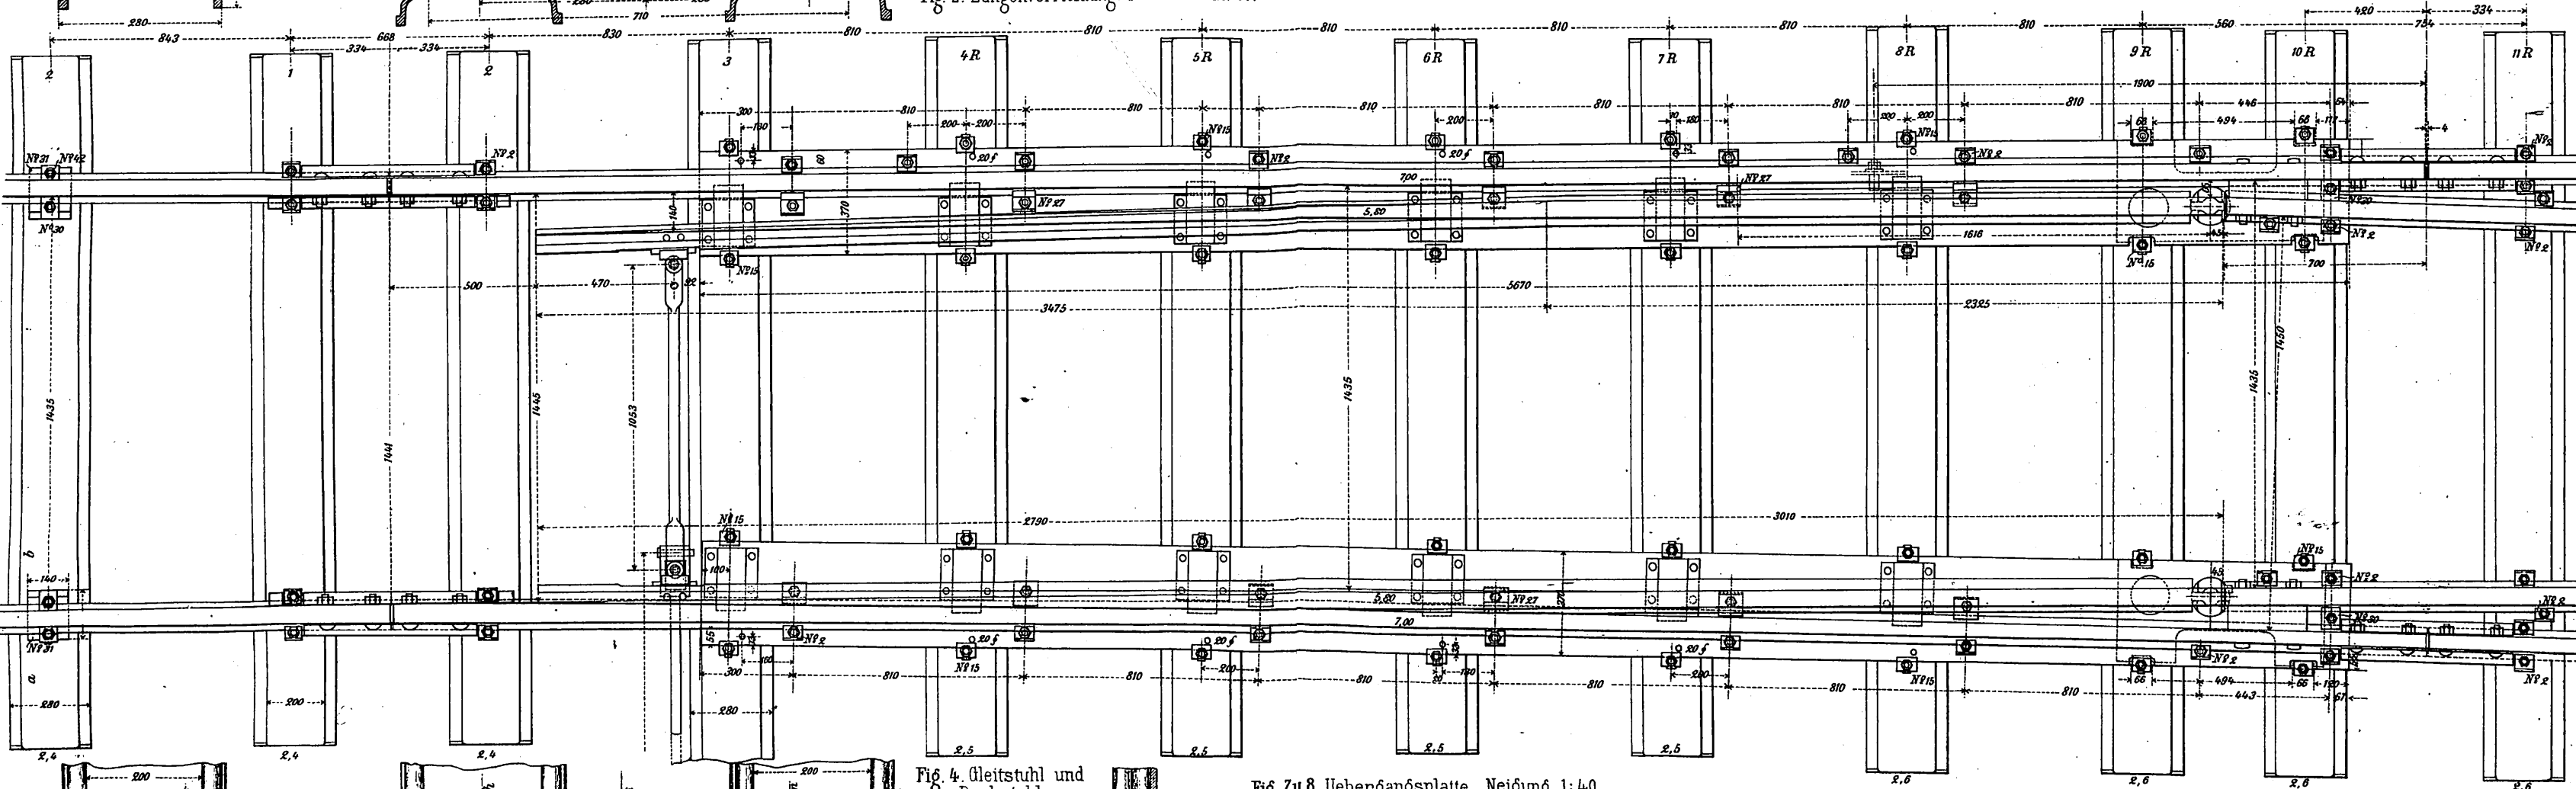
Gleitstuhl und Drehstuhl. Grundriss. 1:10 der nat. Gr.
